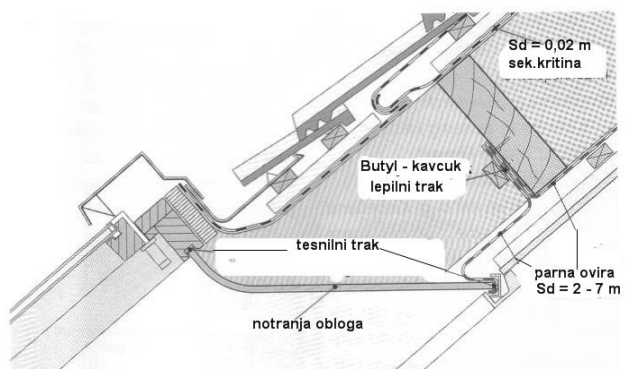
Lepljenje parne ovire konstrukcije - varianta 1 in 2
